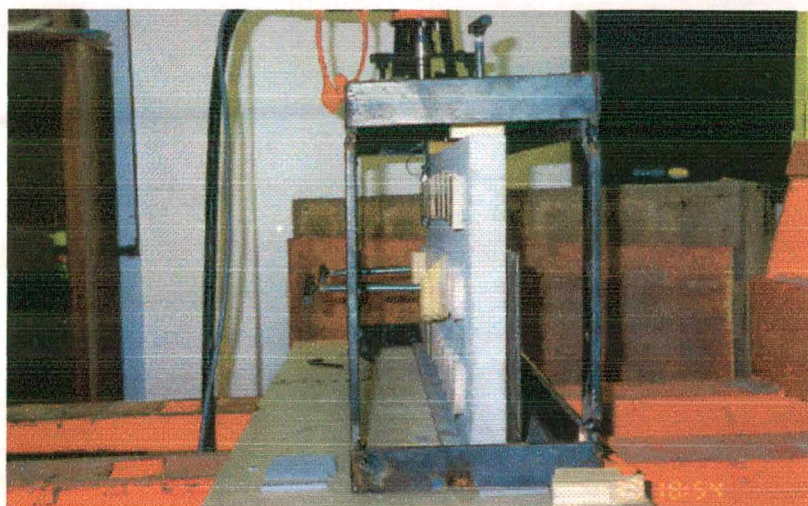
Substrato fixado ao suporte, pronto para o ensaio.
